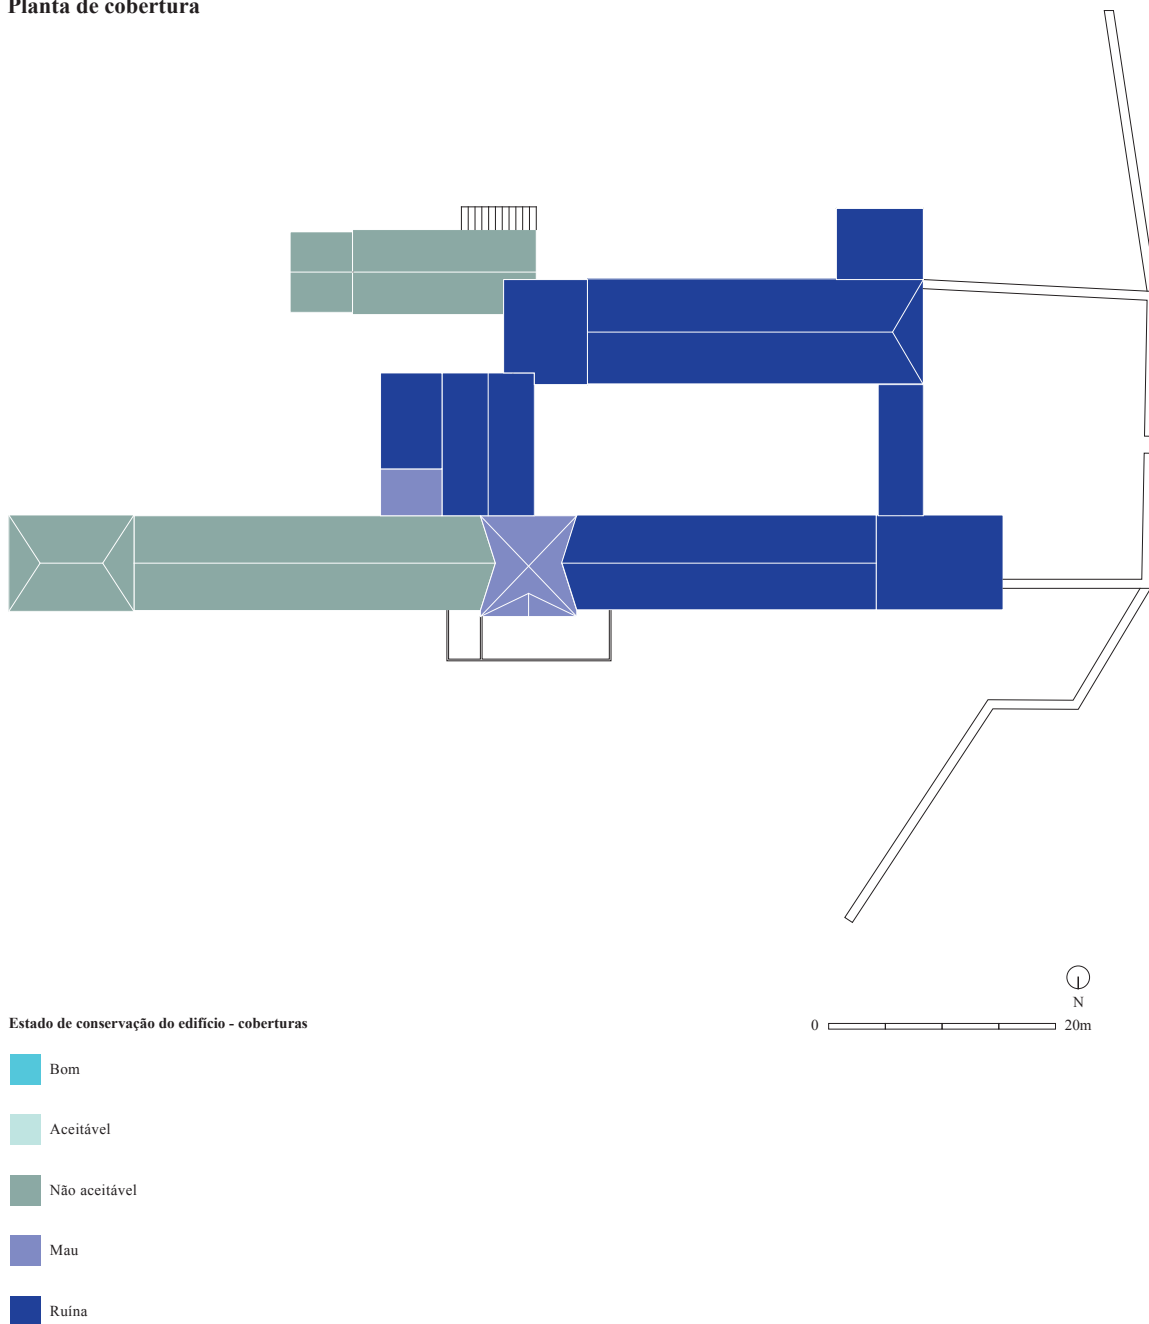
Mapa do estado de conservação do edifício - coberturas
